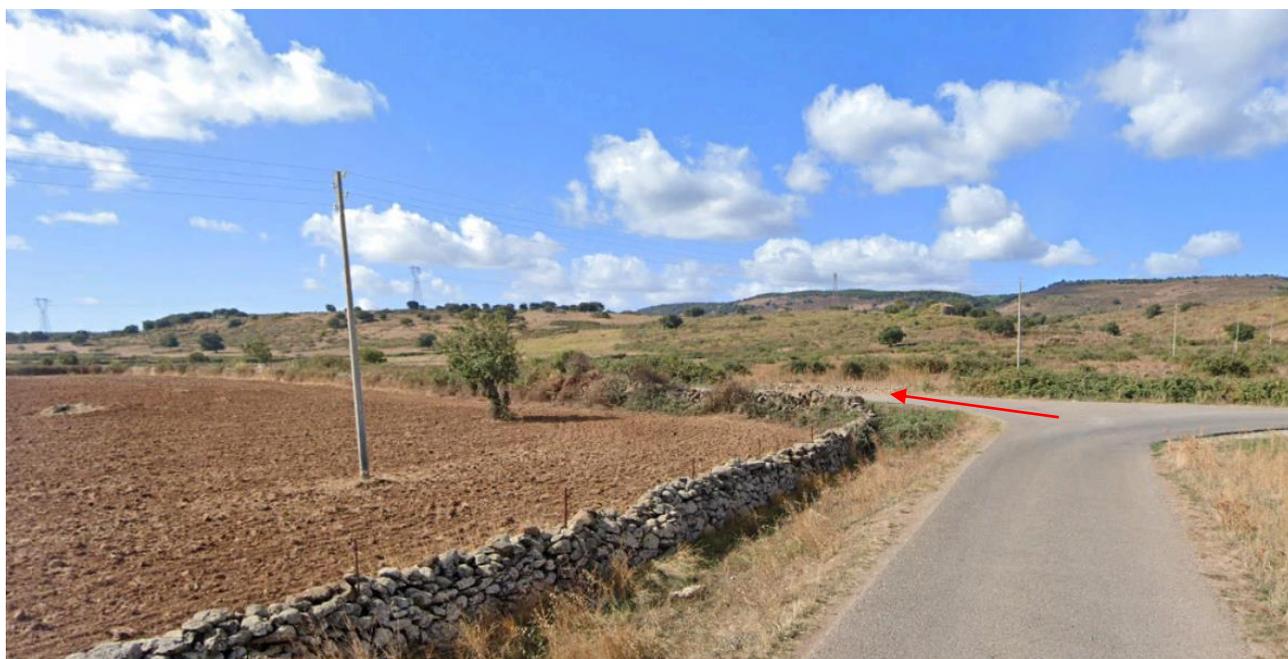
Proseguimento verso sud della strada secondaria lungo la quale corre il tracciato del cavidotto. Foto estrapolata da Google Earth in direzione ovest (P.to 13)
